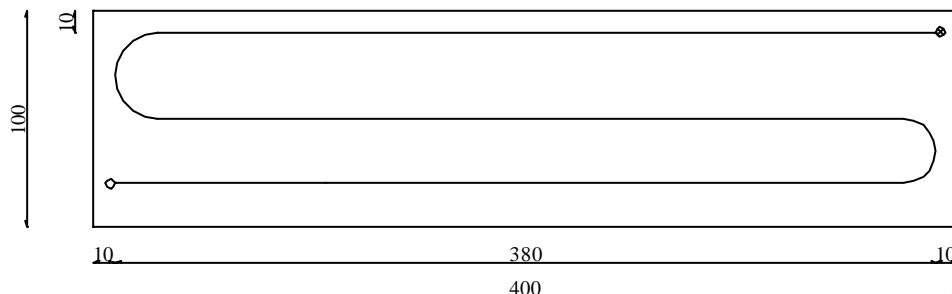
PLANTA DO BLOCO DE TESTES – TFOR, CAMADA INFERIOR
